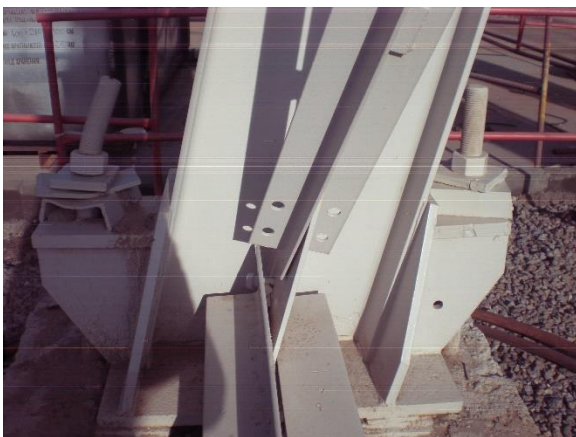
Металлическая опора. Отсутствуют болты и сварные швы между фасонками и элементами решетки, анкерные болты изогнуты.
